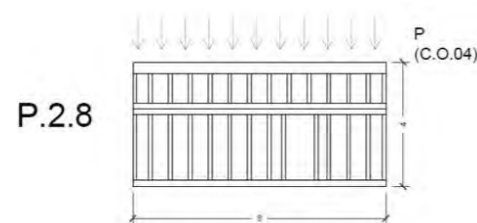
Schema parete P.2.8 (maggiori sollecitazioni). Fonte: Autori.
